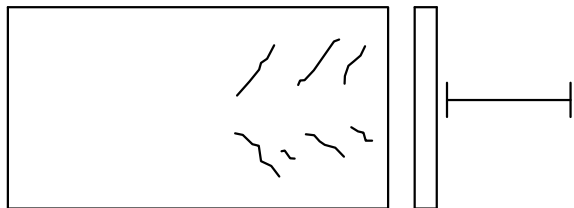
钢-混凝土组合梁梁端 RC 板的鱼骨形裂纹
